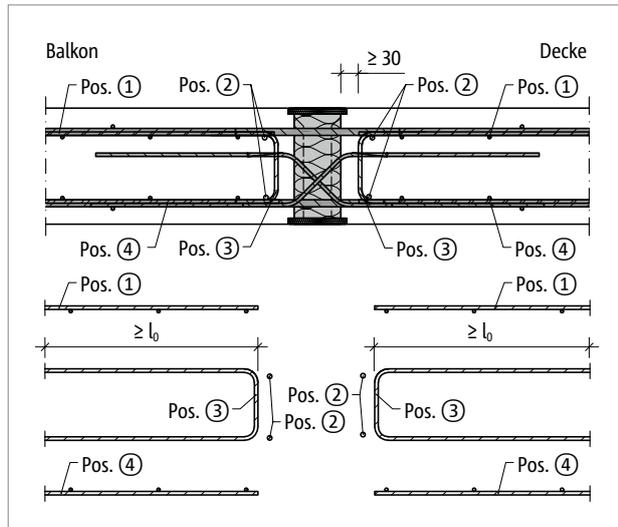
Schöck Isokorb® T Typ D: Bauseitige Bewehrung
